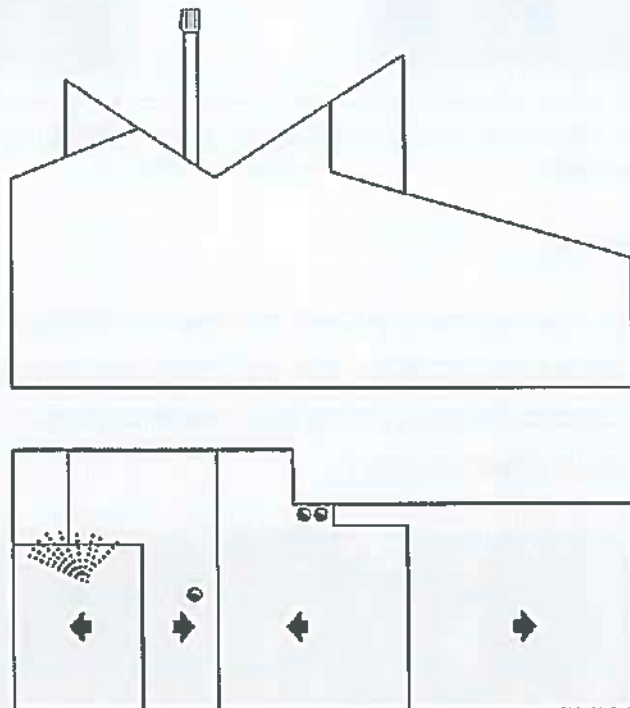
Esquema de cubiertas de la vivienda. Punto singular probado
